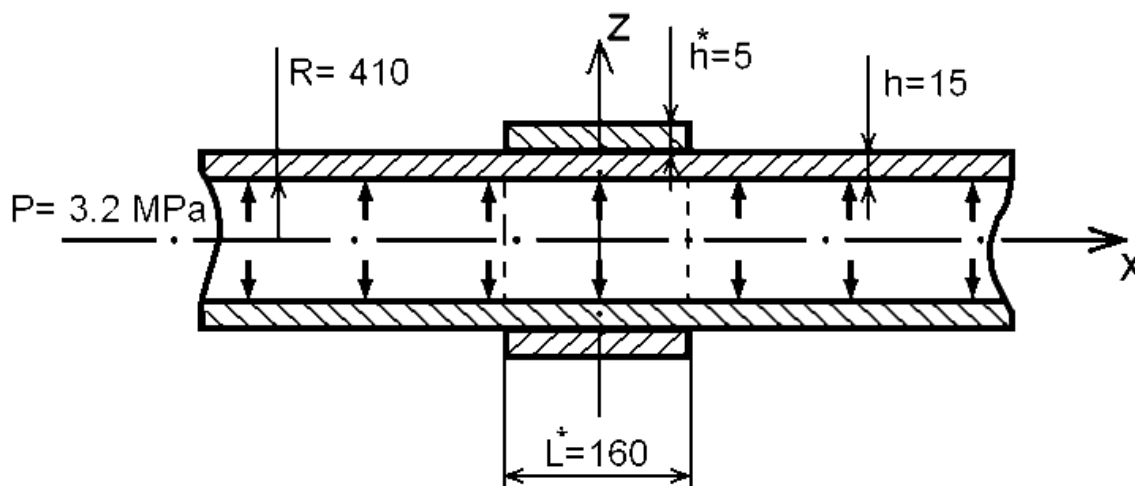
Расчетная схема участка трубопровода с бандажом из КМ
